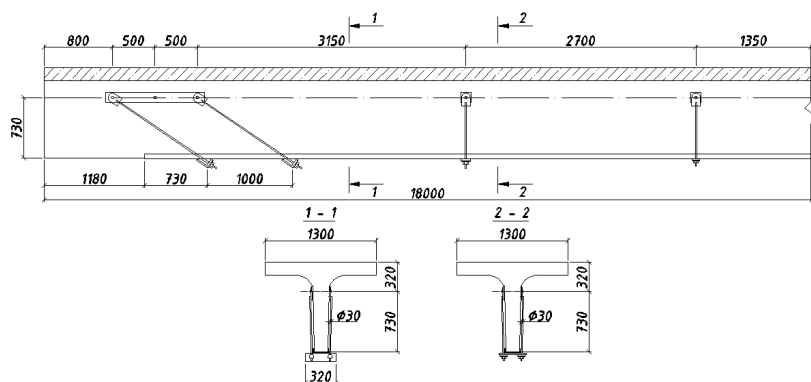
Конструкция усиления главных балок пролетных строений металлом путем наклейки швеллера
